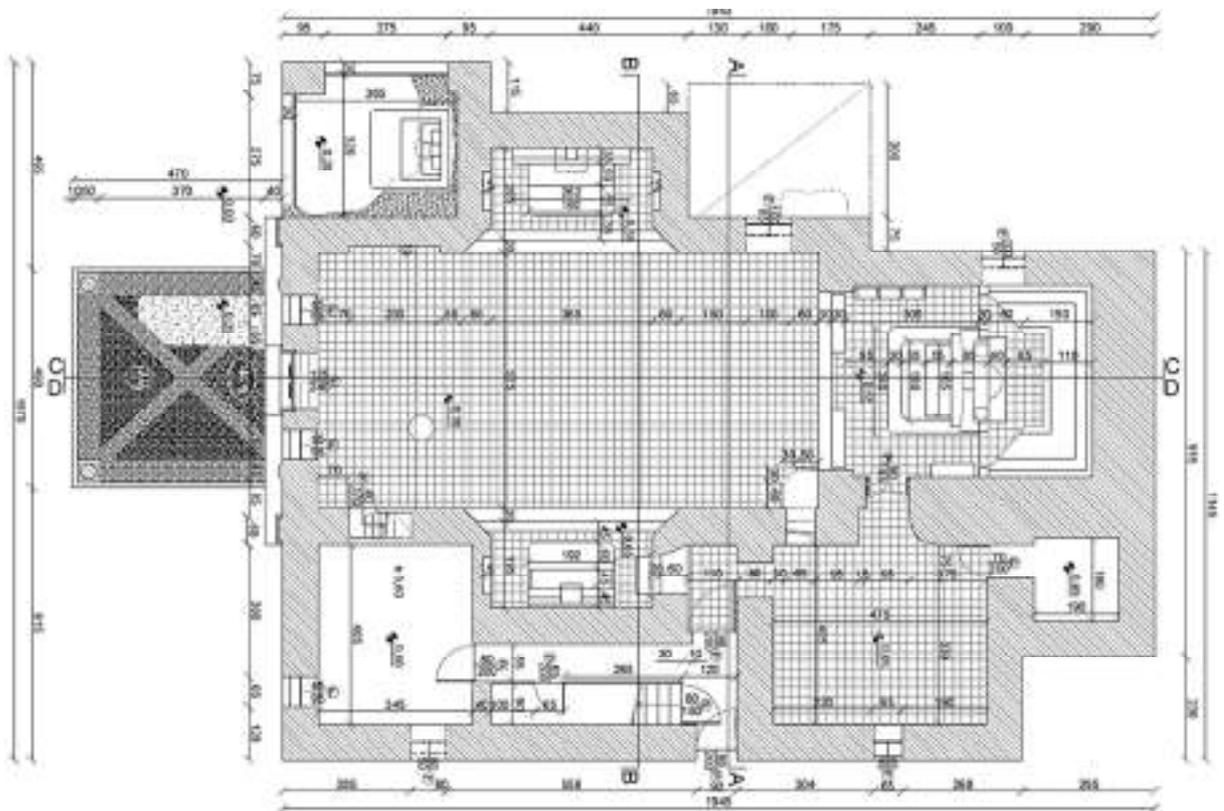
Pianta piano terra (Fonte: Tavola 3B)
